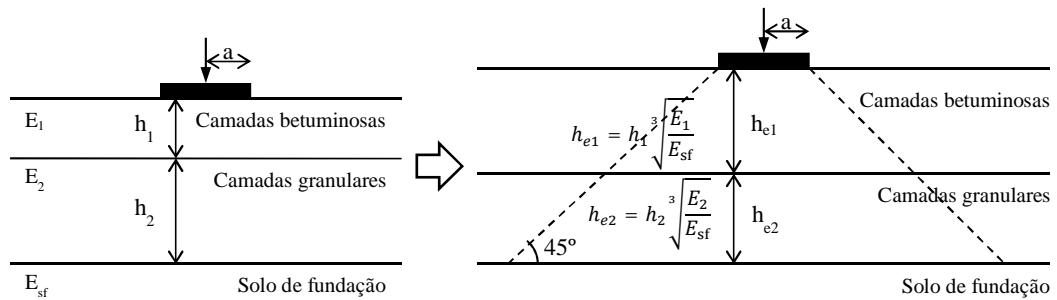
Espessura equivalente das camadas do pavimento tendo como referência o solo de fundação
